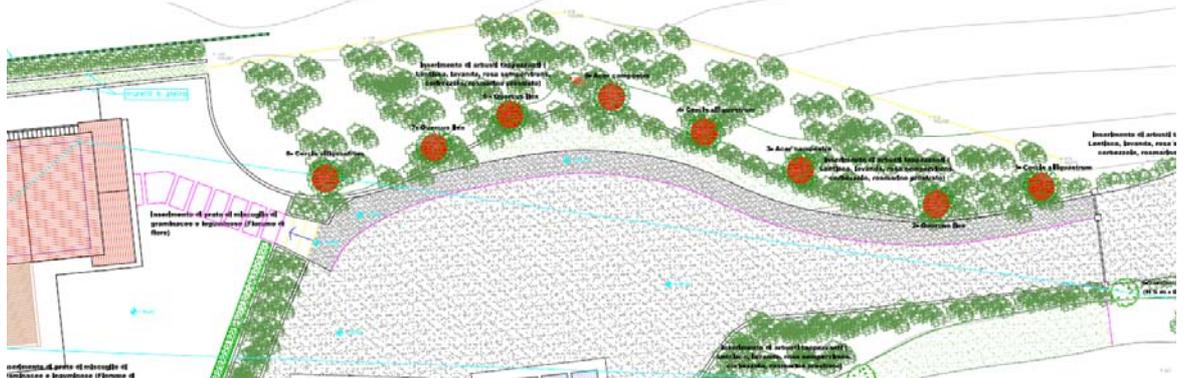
stralcio della Tav. A05b Planimetria Generale – Stato di Progetto – del luglio 2018.
